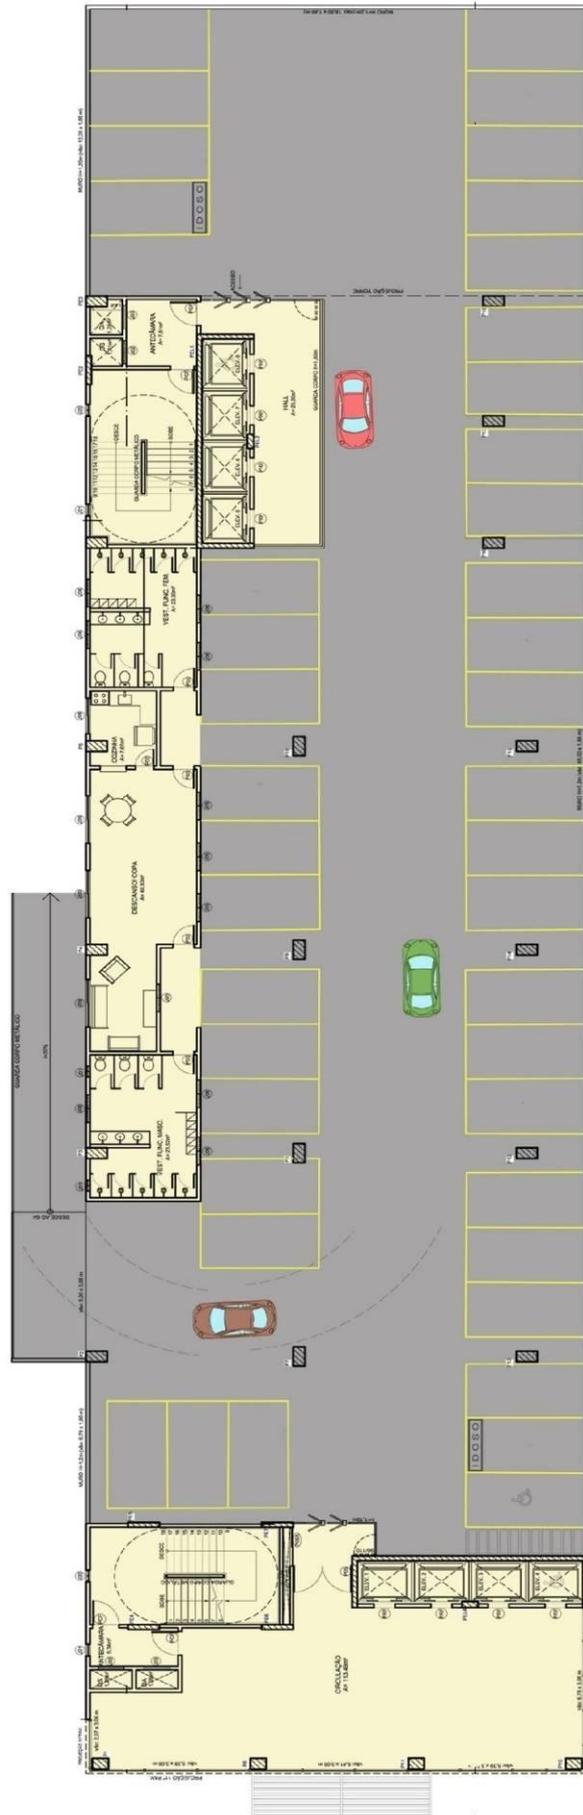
Representação em planta baixa do Pavimento G4 (garagem)
